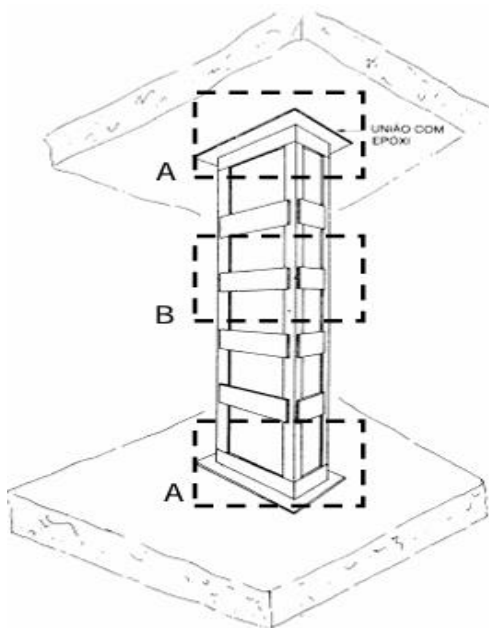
Pilar reforçado com armaduras exteriores (17).
